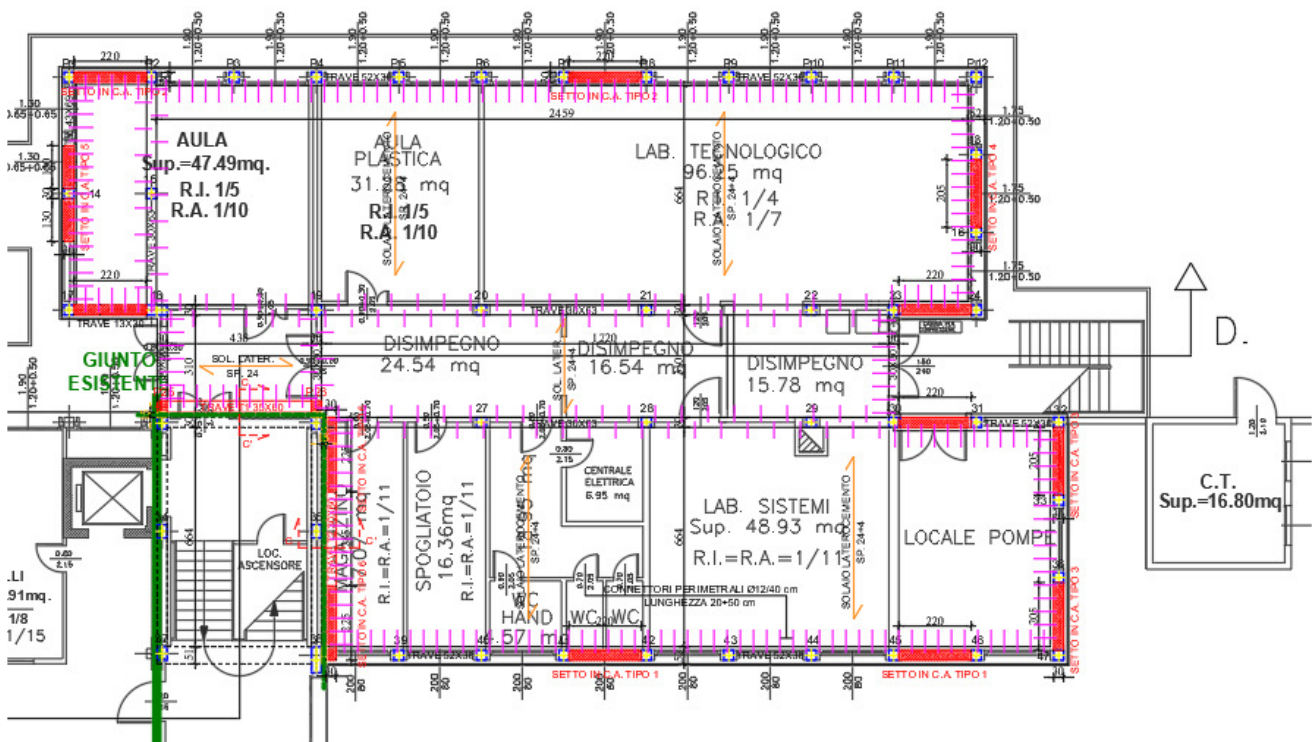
Lavori strutturali LOTTO 1 – piano terra
